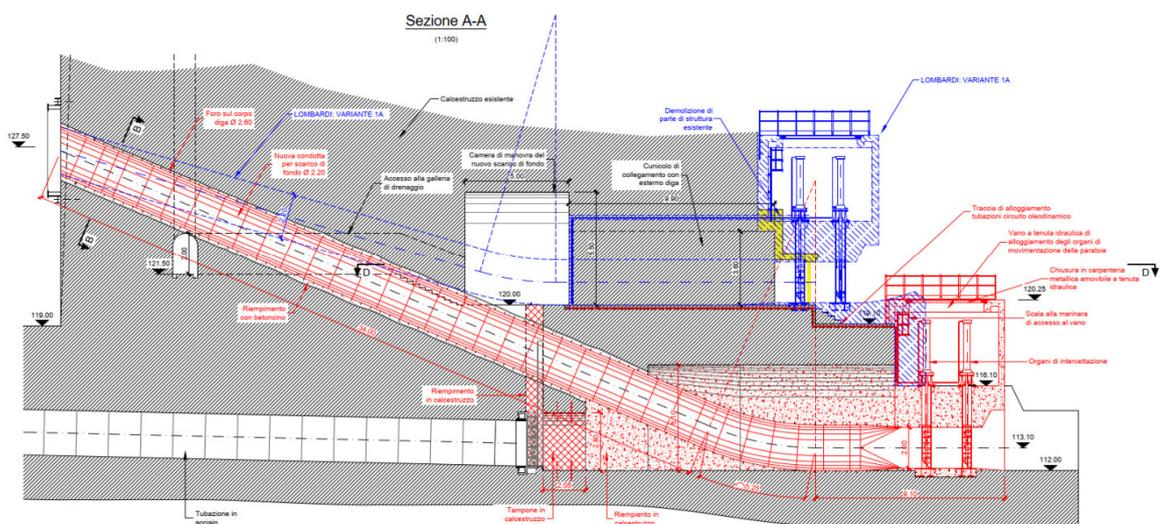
Sezione del nuovo scarico di fondo (rosso: progetto definitivo ENEL, blu: variante Lombardi).
